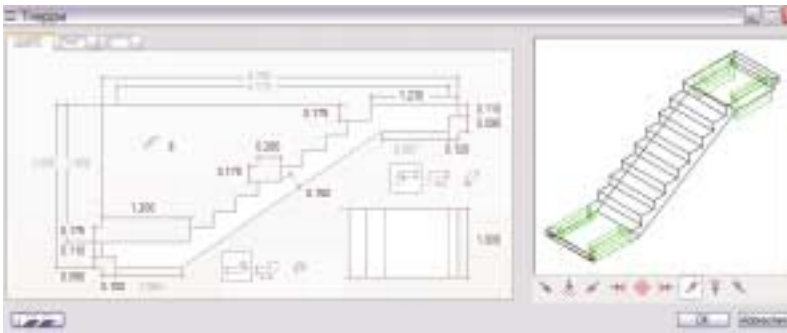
Allplan Treppe mit parametrisierter Eingabe, Details für den Treppenfuß
